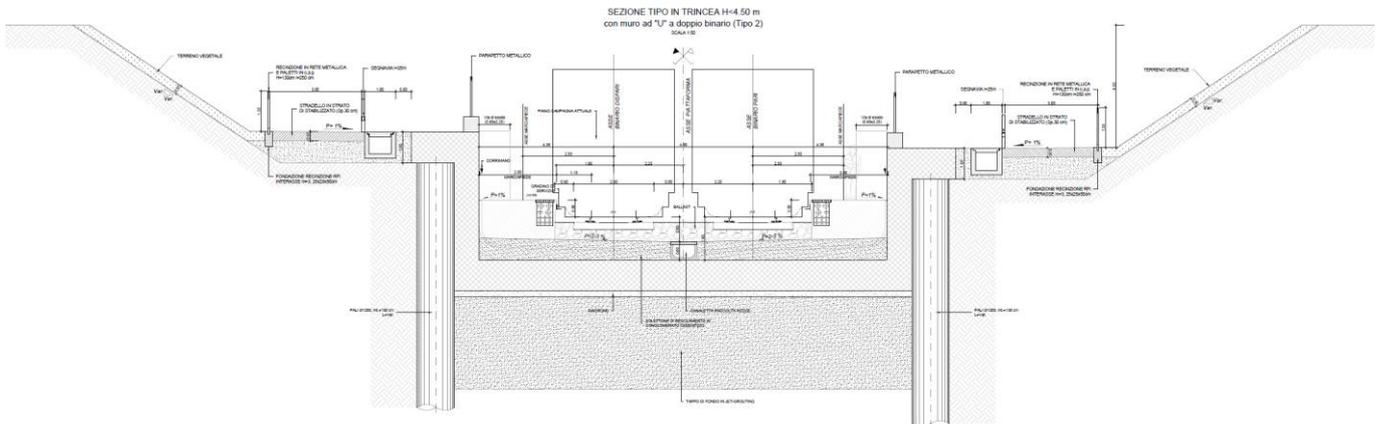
Sezione tipo in trincea H>4.50m a doppio binario con muro ad U
